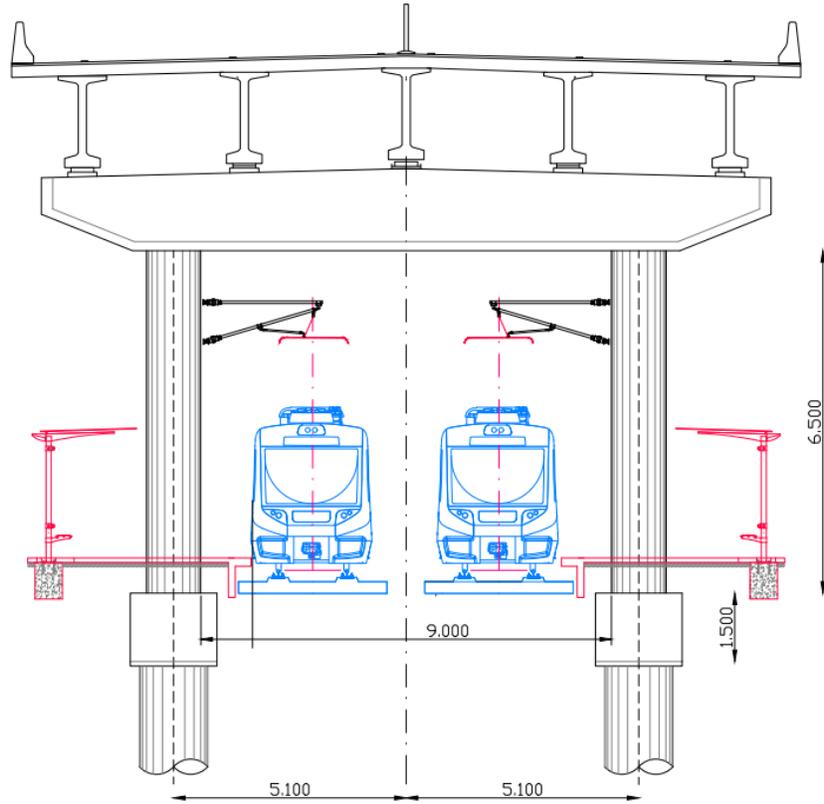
Propuesta 1 estación bajo viaducto. Pila P57, PK 29+100.
